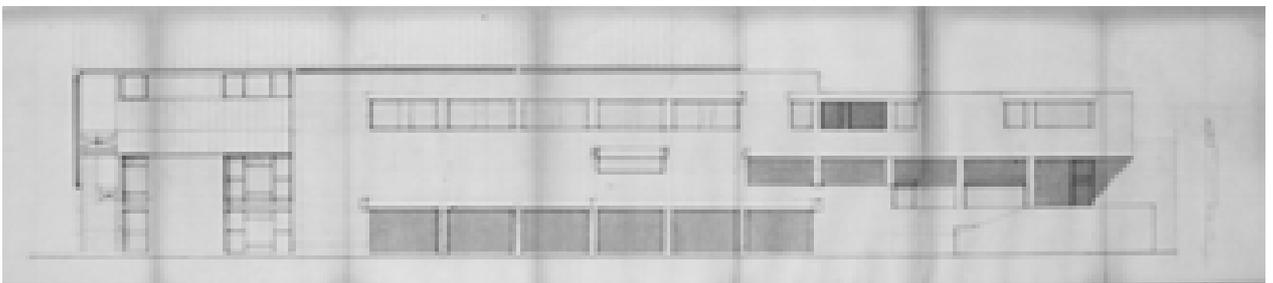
Prospetto, Ovest –08/12/1981 (AABS-1996.650)
